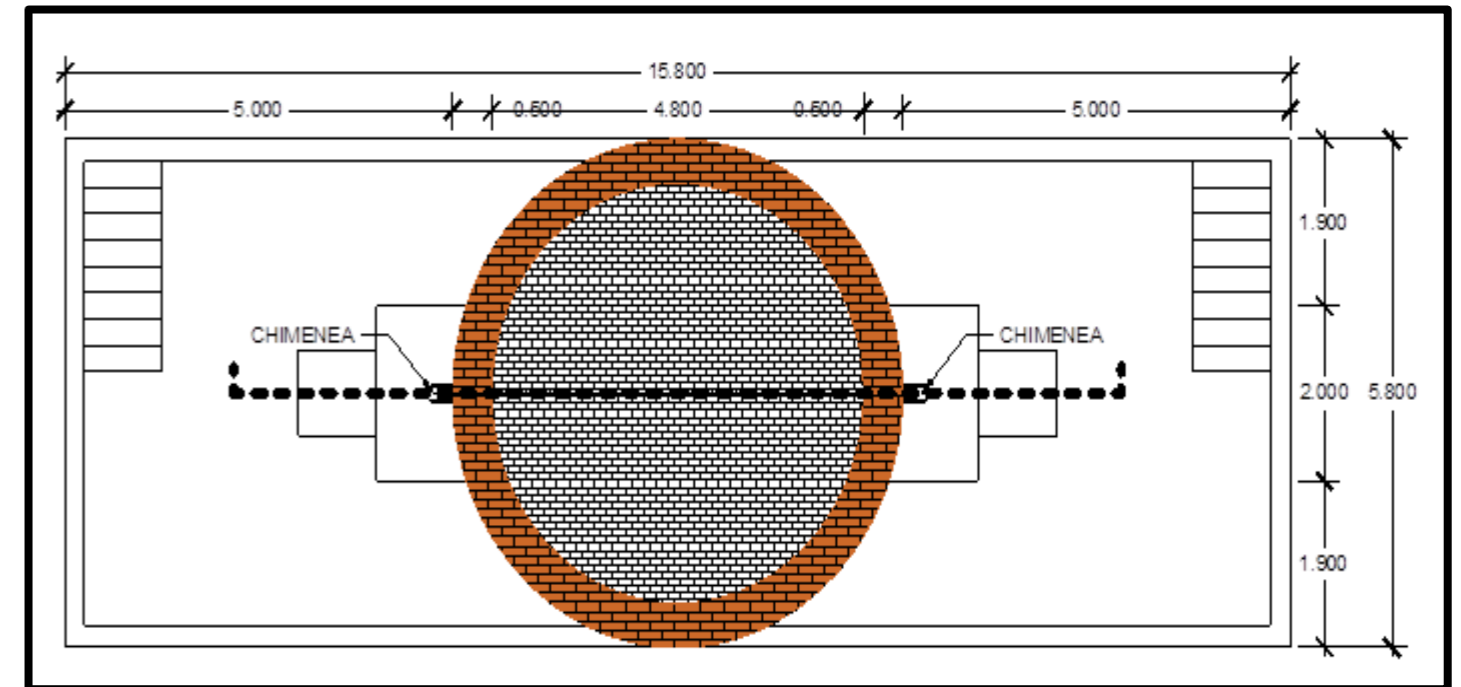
PLANTA ARQUITECTONICA – PROPUESTA "B".
